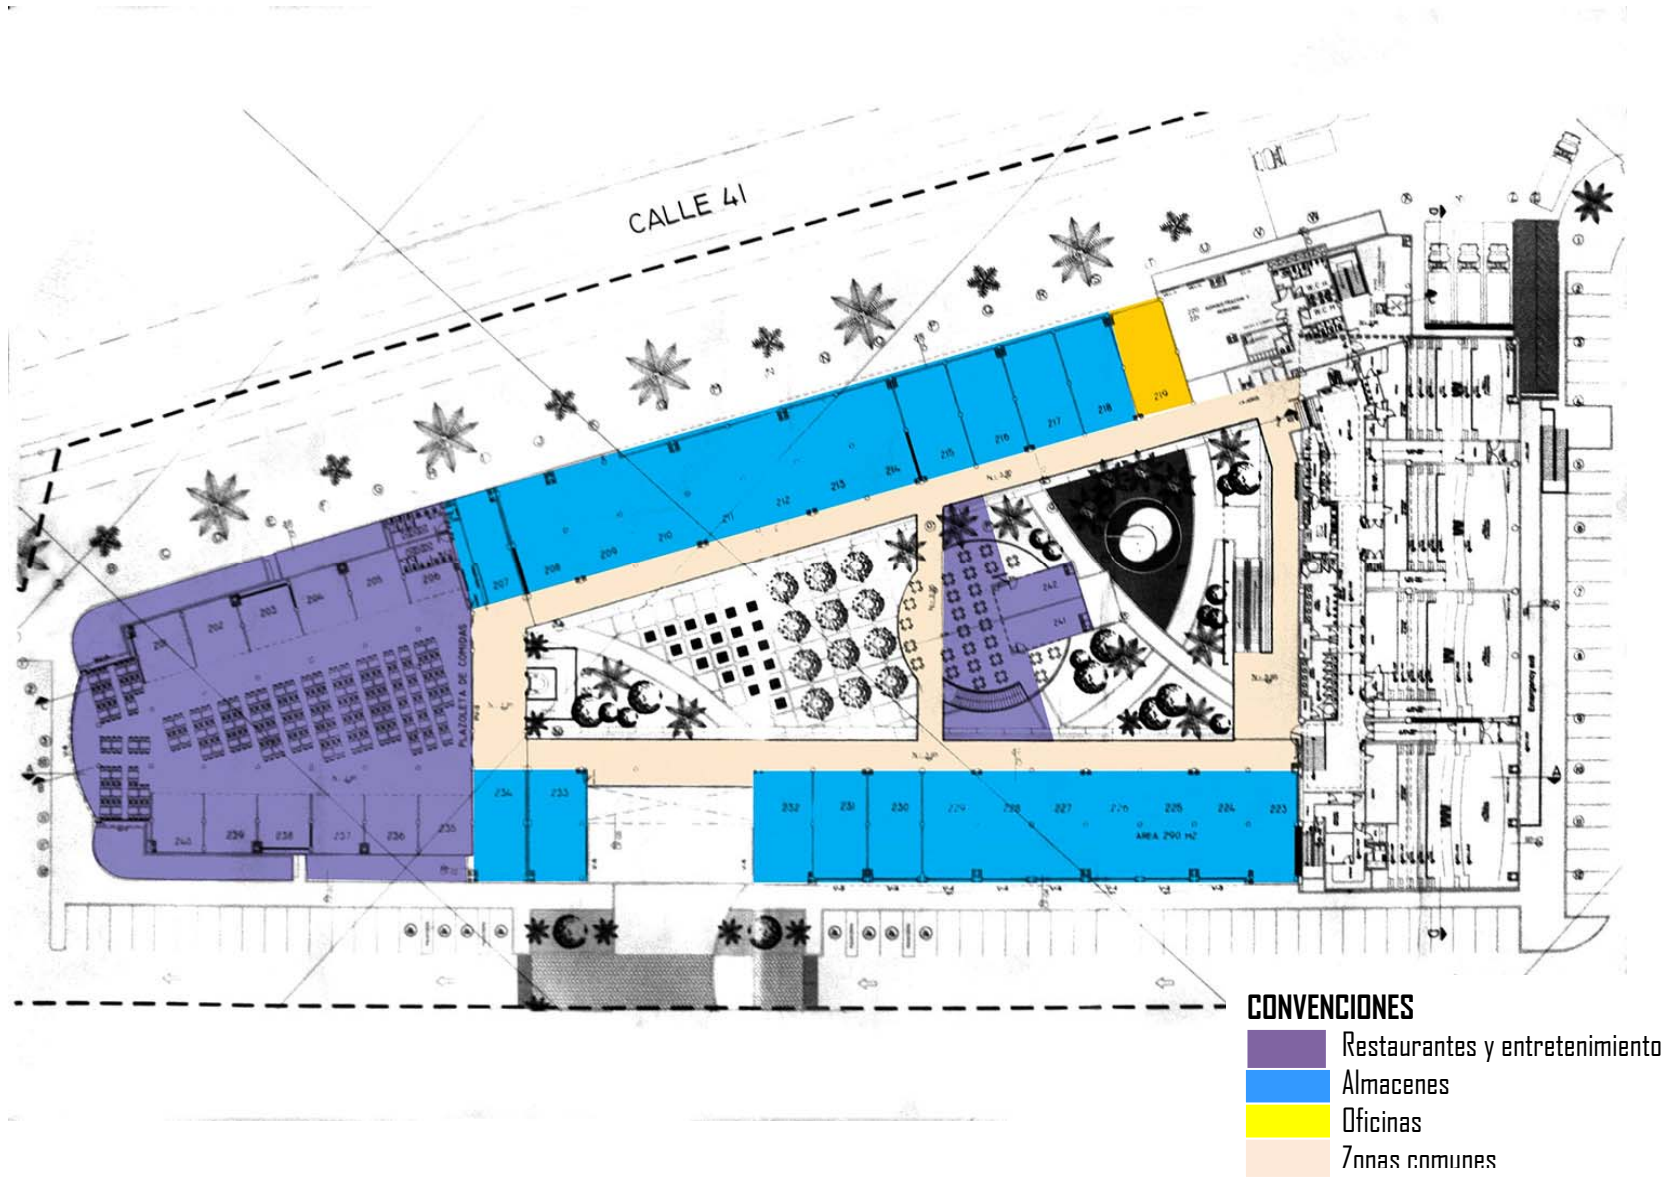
Segunda planta del centro comercial San Pedro Plaza
